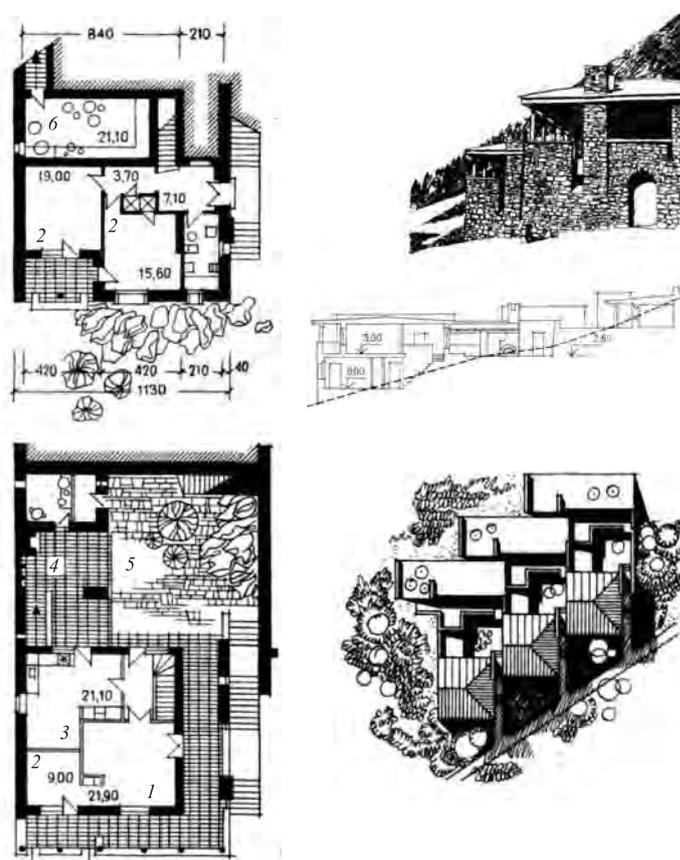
Высокогорное село Гудани (Грузия). Пример террасной застройки в сельском строительстве. Общий вид, план первого этажа, план второго этажа, генеральный план, разрез: 1 — общая комната; 2 — спальни; 3 — кухня-столовая; 4 — летняя кухня; 5 — внутренний дворик; 6 — подвал
